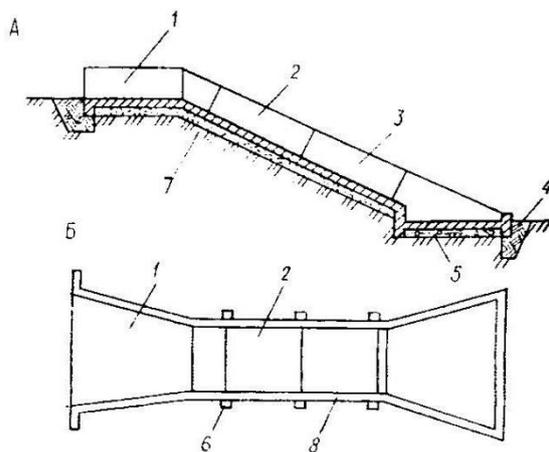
Схема быстротока: А – продольный разрез; Б – план; 1 – водоприемник; 2 – лоток; 3 – водовыпуск; 4 – глиняный замок; 5 – щебень; 6 – упорный брус; 7 – основание сооружения; 8 – стенки сооружения.
